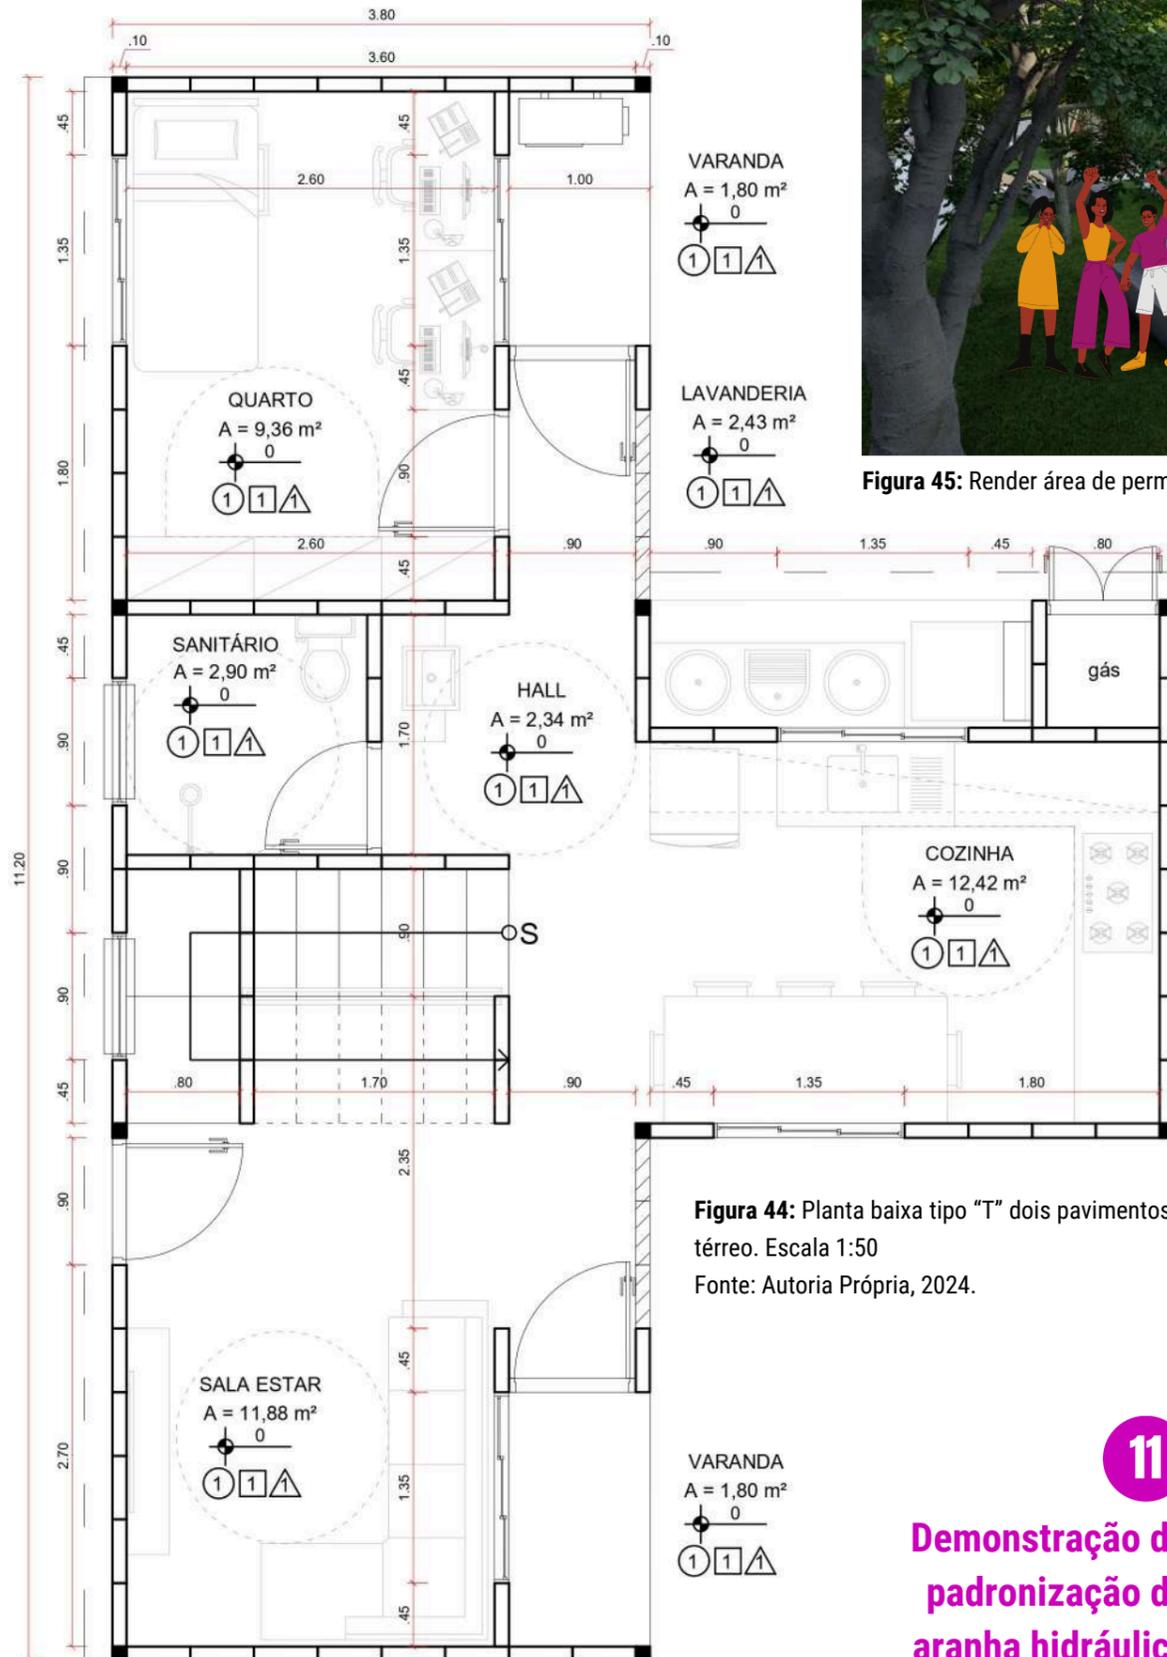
Planta baixa tipo "T" dois pavimentos, térreo. Escala 1:50
